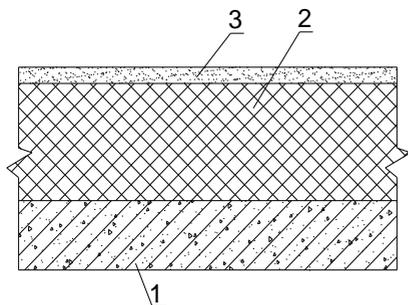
Чердачное перекрытие жилого здания:
